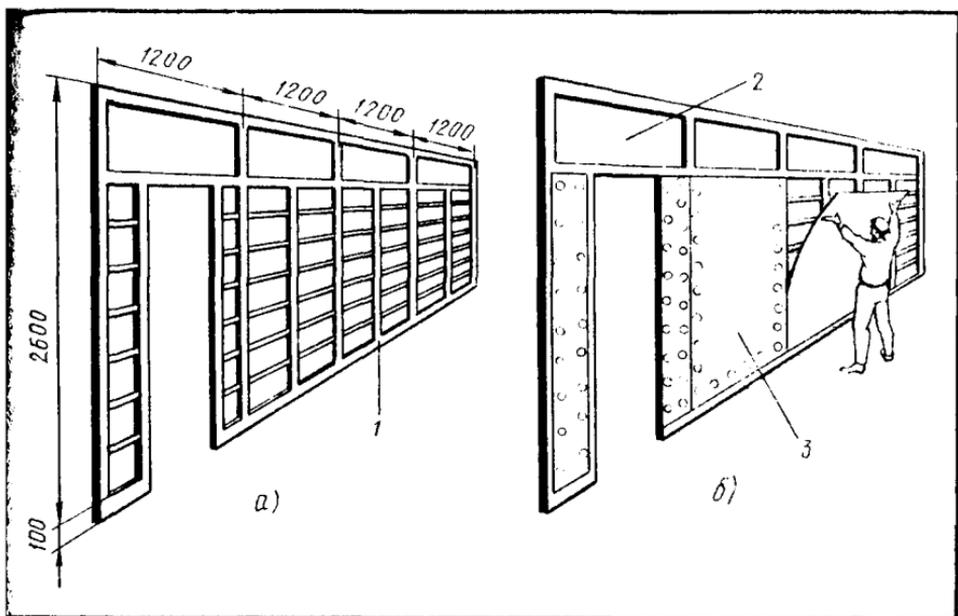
Крепление твердых древесноволокнистых плит раскладками из пластмассы или алюминия:
